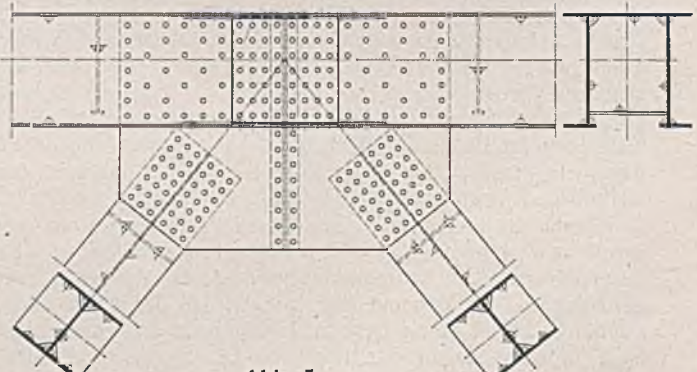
Darstellung eines Knotenpunktes einer 90-m-Öffnung. Die eigentlichen Gurtstäbe haben alle gleichen Querschnitt, alle Knoten sind gleichmäßig ausgebildet.
